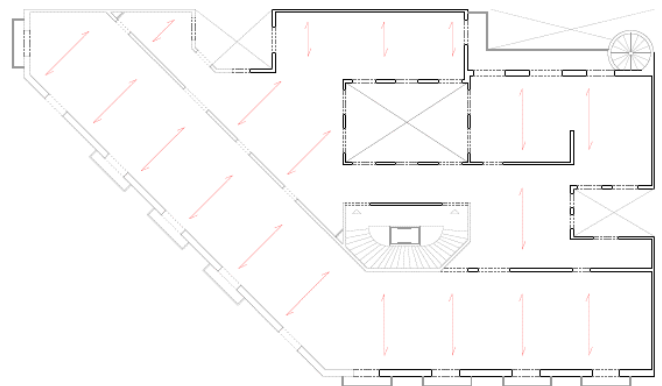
Plano estructural de la distribución en planta del edificio de la calle de Pau Claris 96 extraído de Cornadó (2015)
